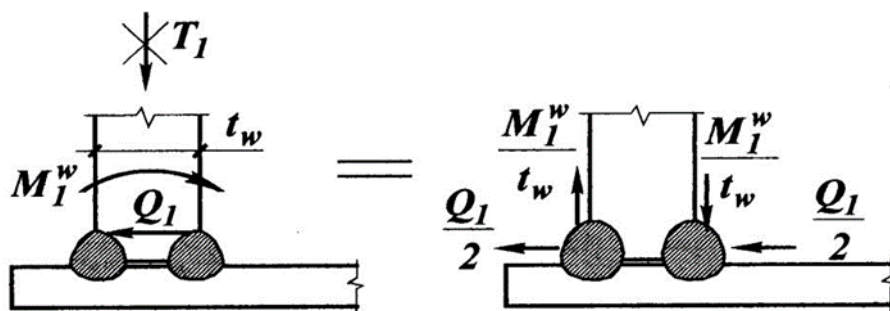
Расчётная схема сварного шва, соединяющего стенку с дном
